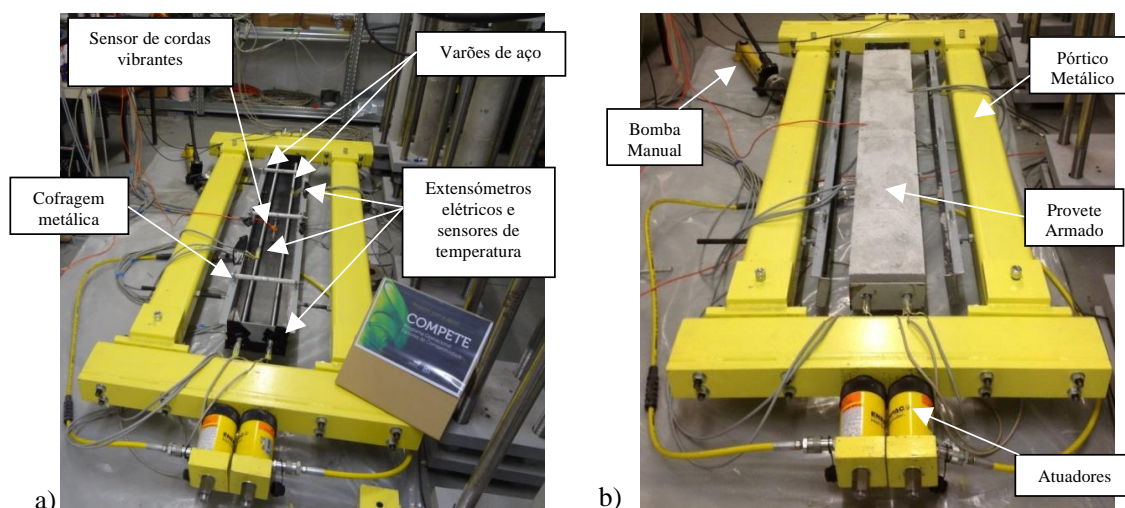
Sistema de ensaio desenvolvido por Teixeira et al. (2012) a) Antes da betonagem; b) Depois da betonagem
